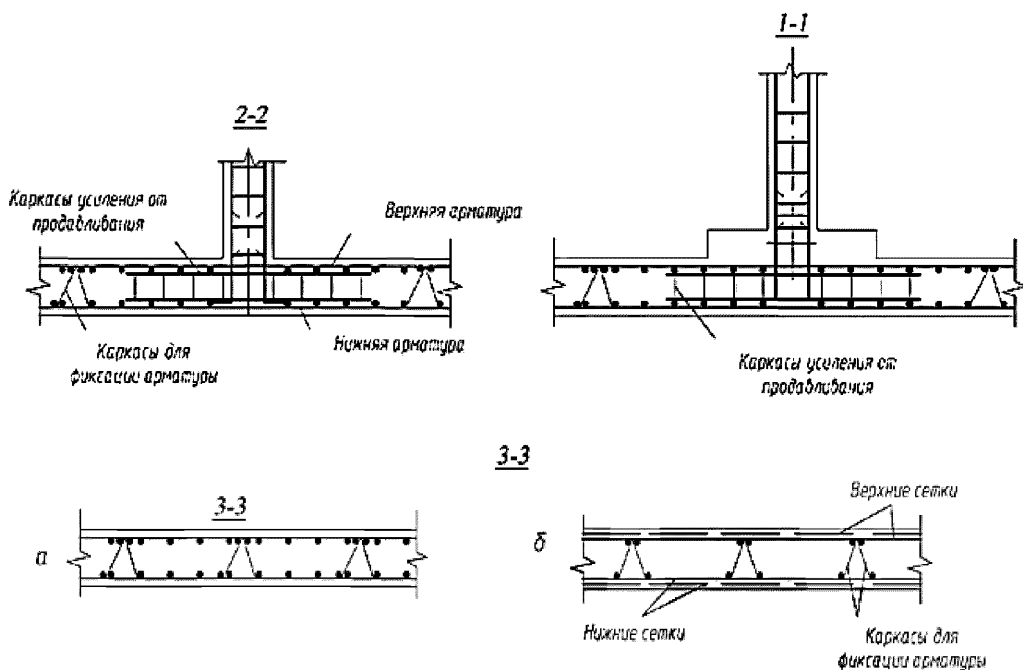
Армирование сплошных плоских фундаментов:
